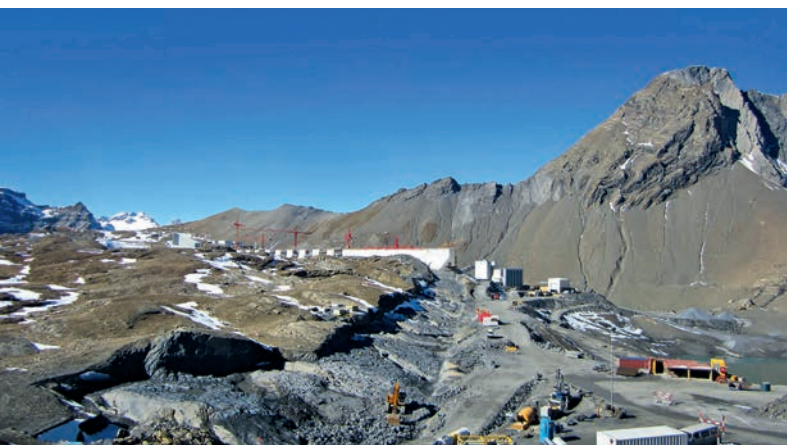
Bau der Staumauer mit der Bergstation der Bauseilbahn 2 (links hinten). Links der Staumauer (Luftseite) befindet sich die eingesetzte Schutzzone Muttan. | Figure 9 : Construction du barrage avec la station supérieure du téléphérique de chantier 2 [derrière à gauche]. A gauche du barrage (parement aval) se trouve la zone de protection de Muttan.
